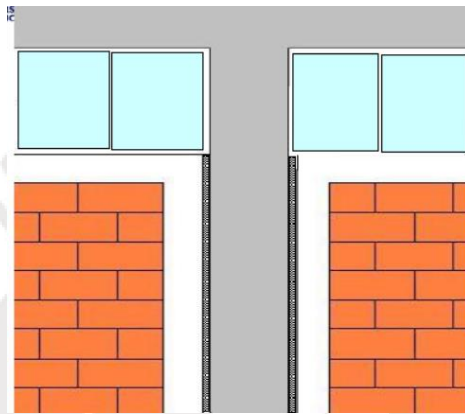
Junta para separar columna de tabiquería (Muñoz, 2019)
